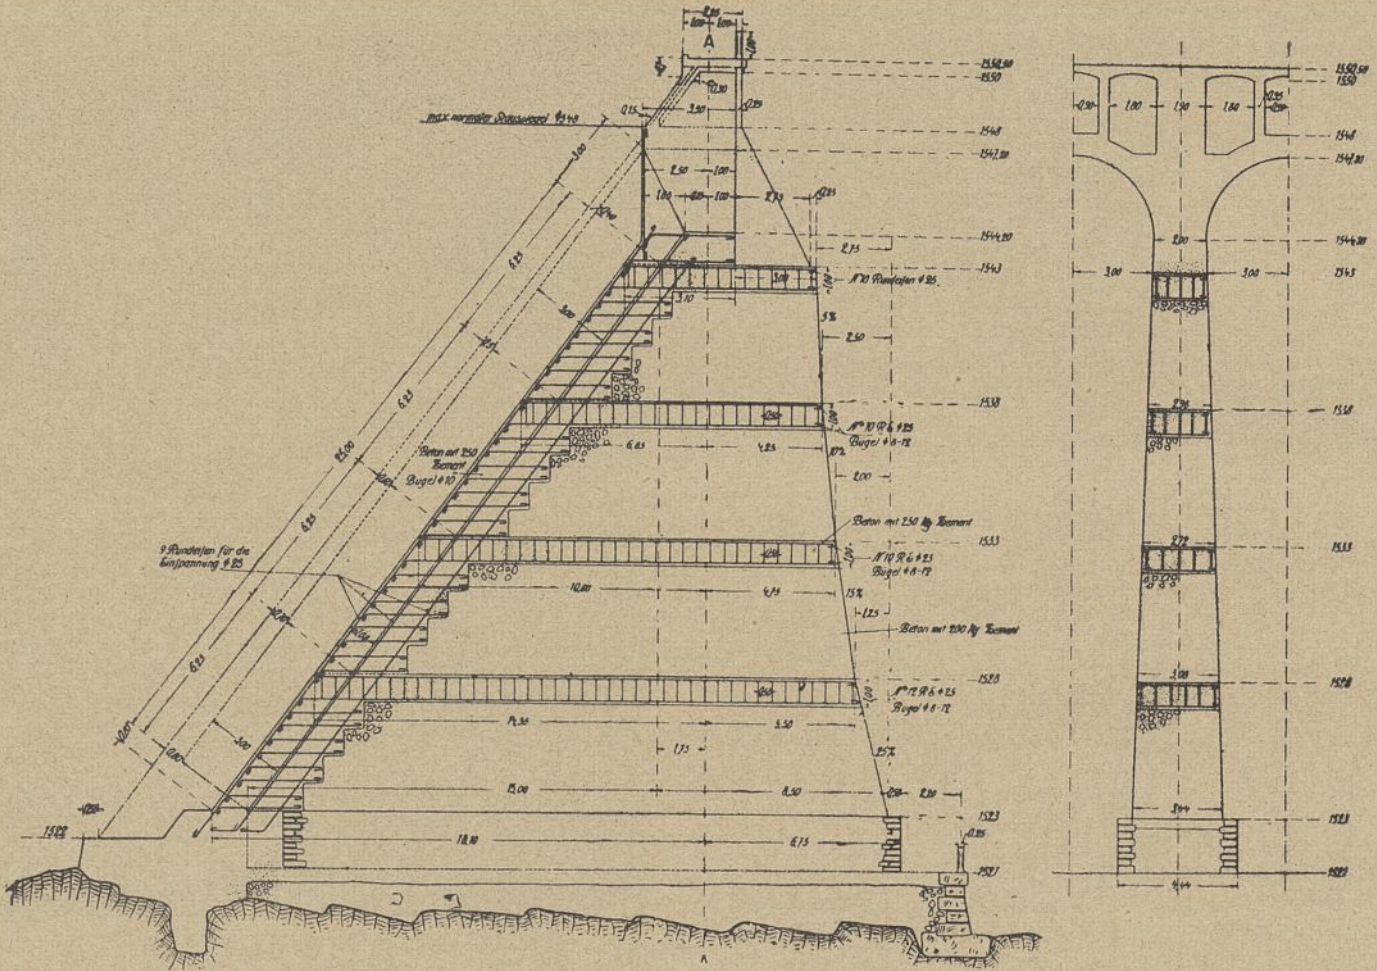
Bewehrungsplan eines Pfeilers. M. 1:275.
